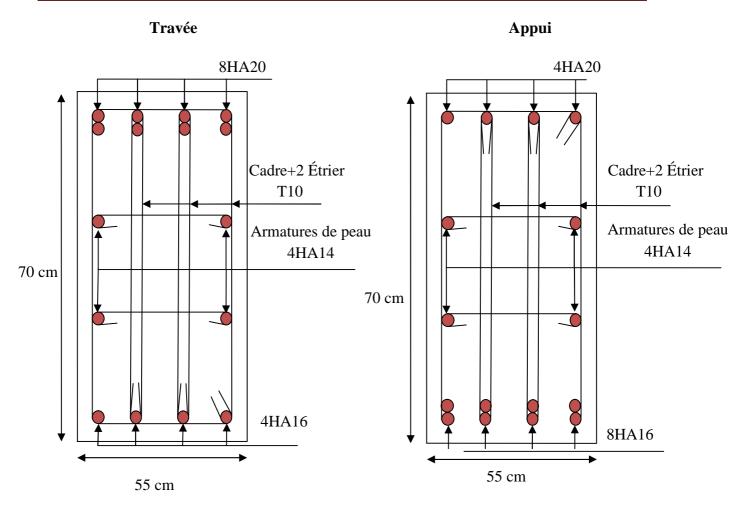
Schéma de ferraillage de la nervure Sens x-x
